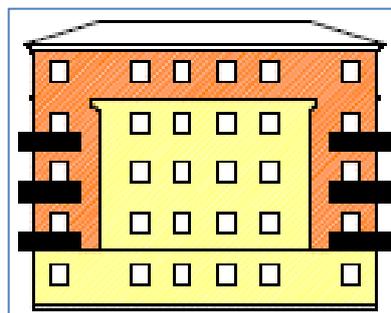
Imagen distribución de fachadas por tipologías en Fachadas Este y Oeste.
